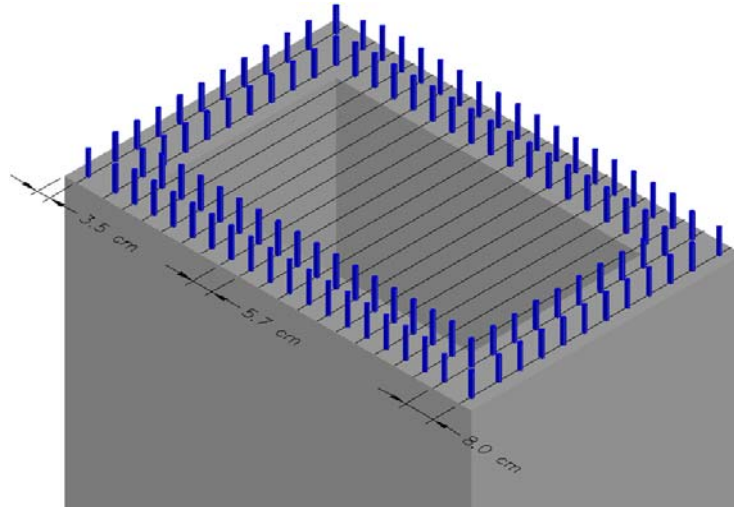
Discretización unidimensional de la sección transversal de la pila
